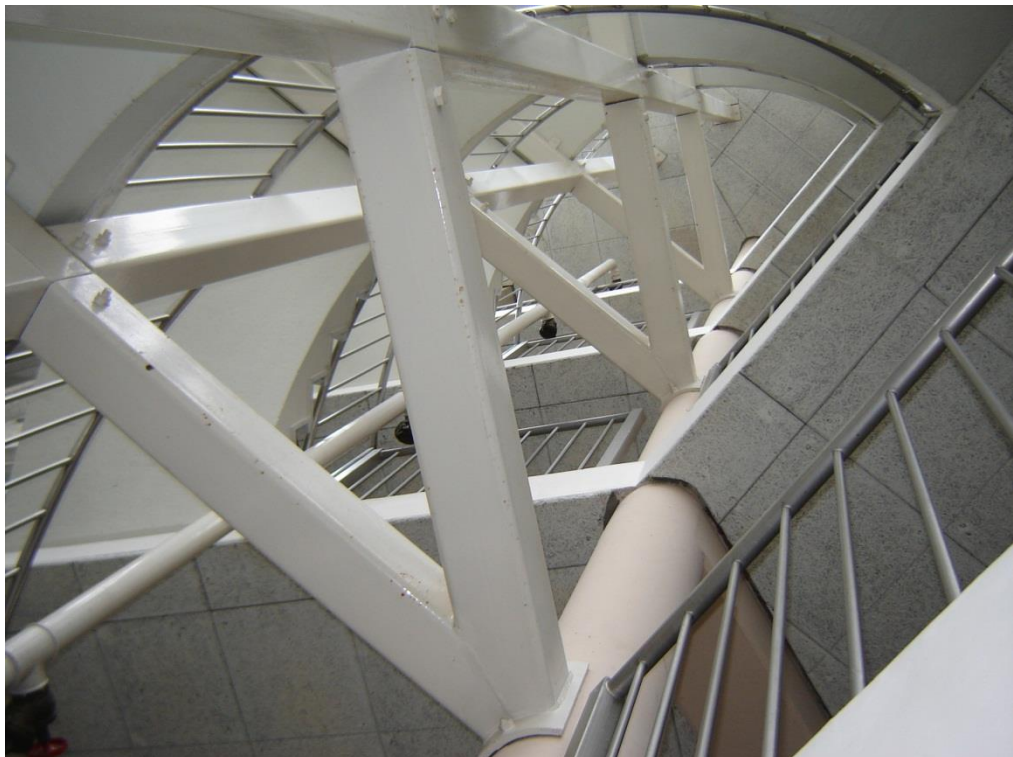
Hoofdtrappenhuis met staalconstructie gekoppeld aan betonkolommen.
